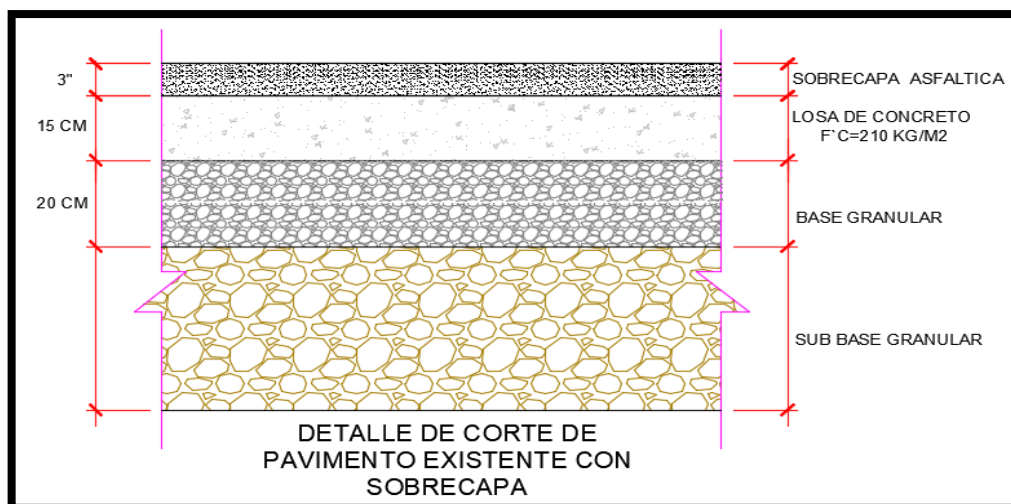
Detalle propuesta estructural del pavimento según diseño
